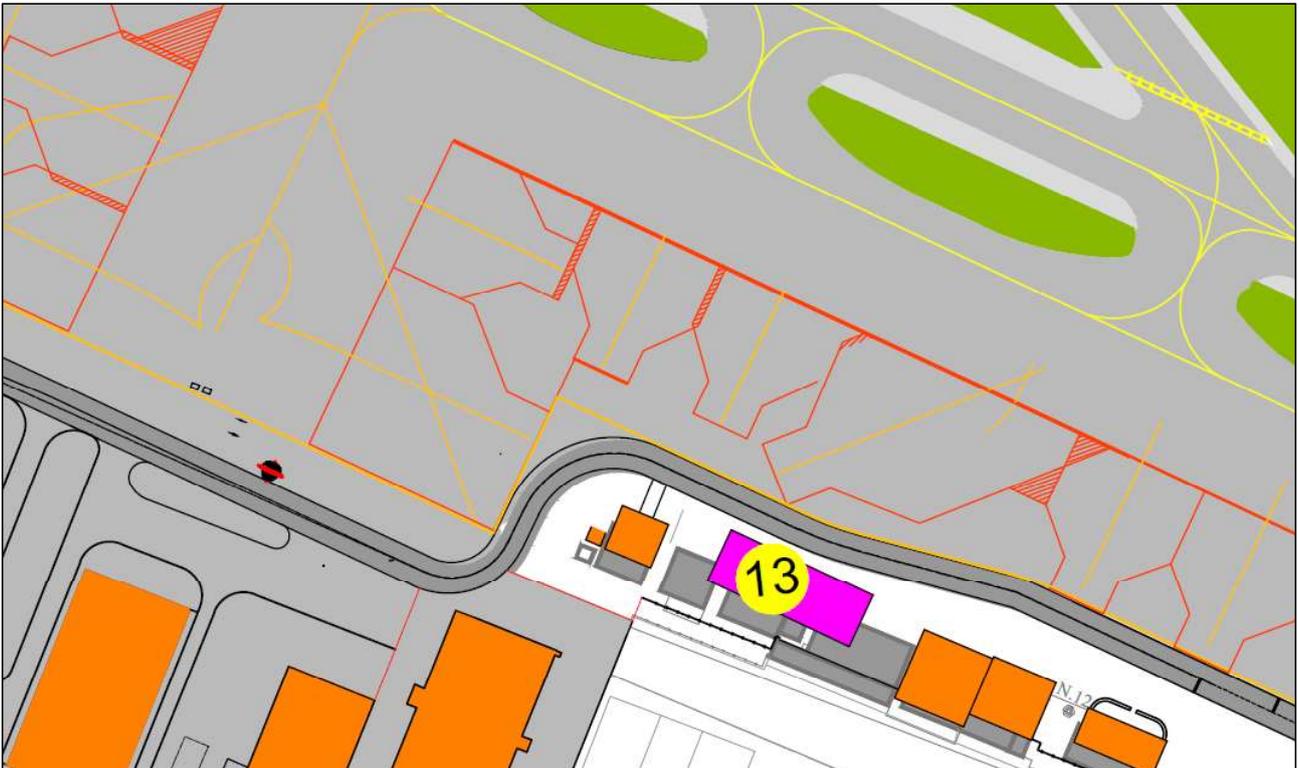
Estratto Master Plan – Nuova Caserma dei Vigili del Fuoco
